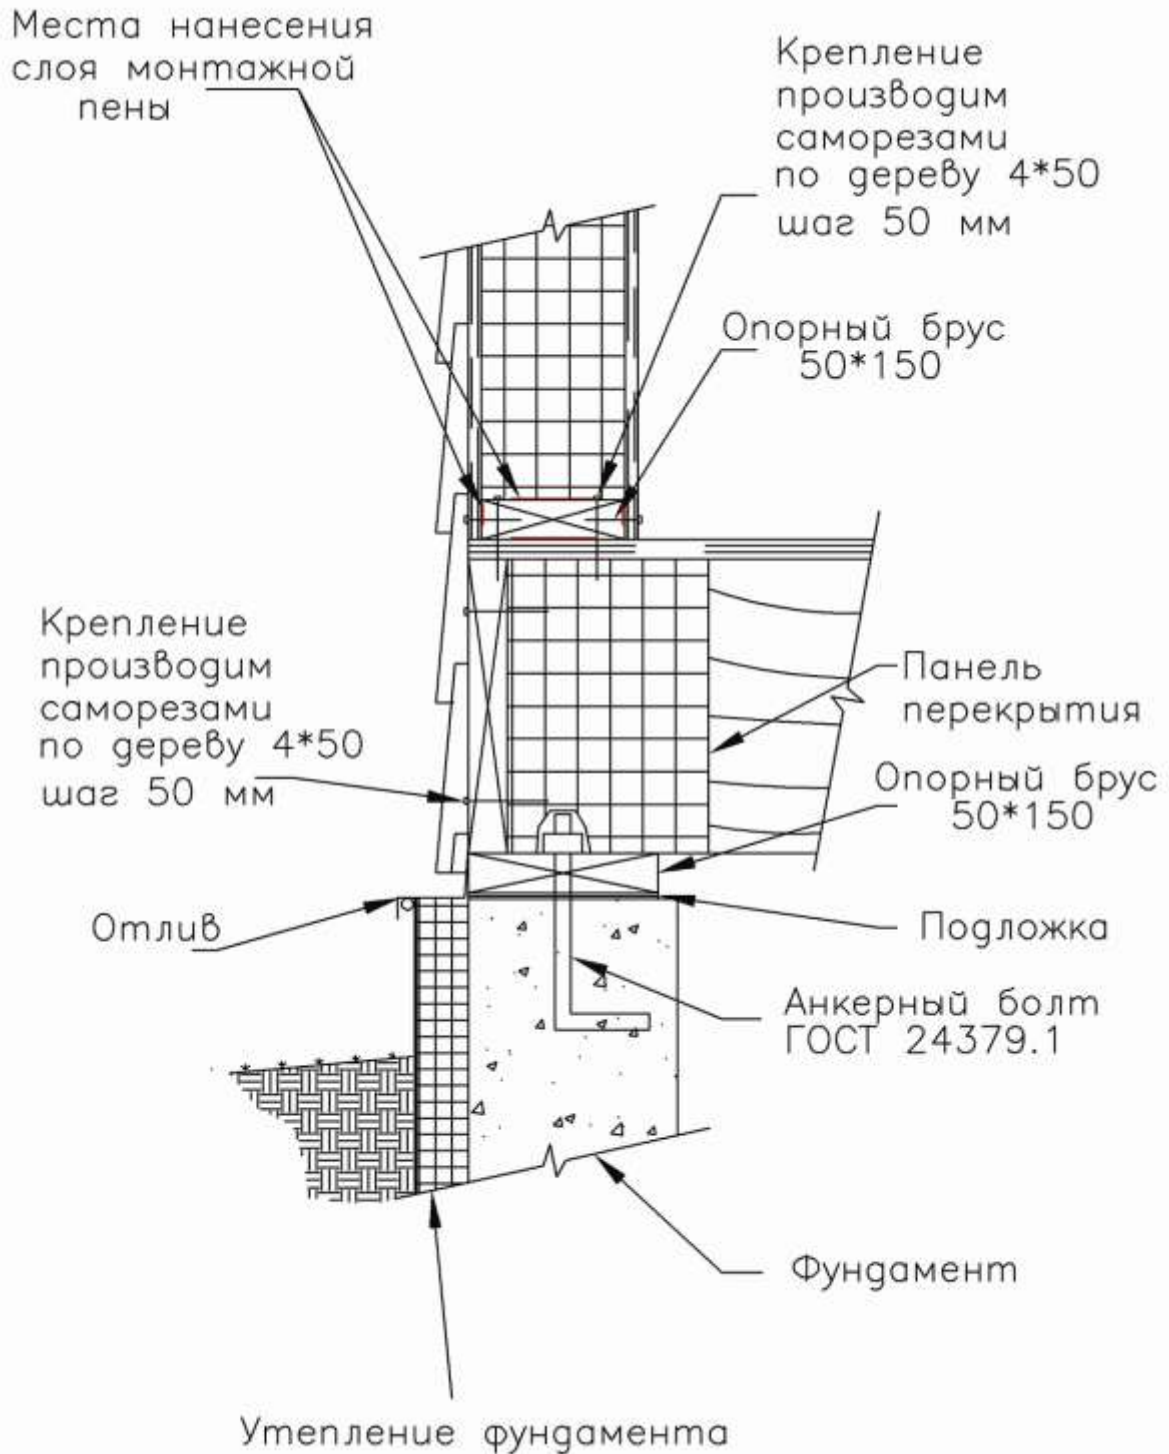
Соединение стеновой панели, перекрытия с фундаментом.
